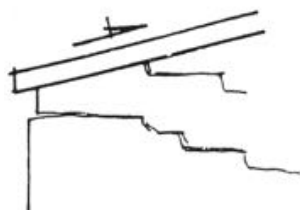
a : RETRACCIÓN FORJADO DE CUBIERTA
